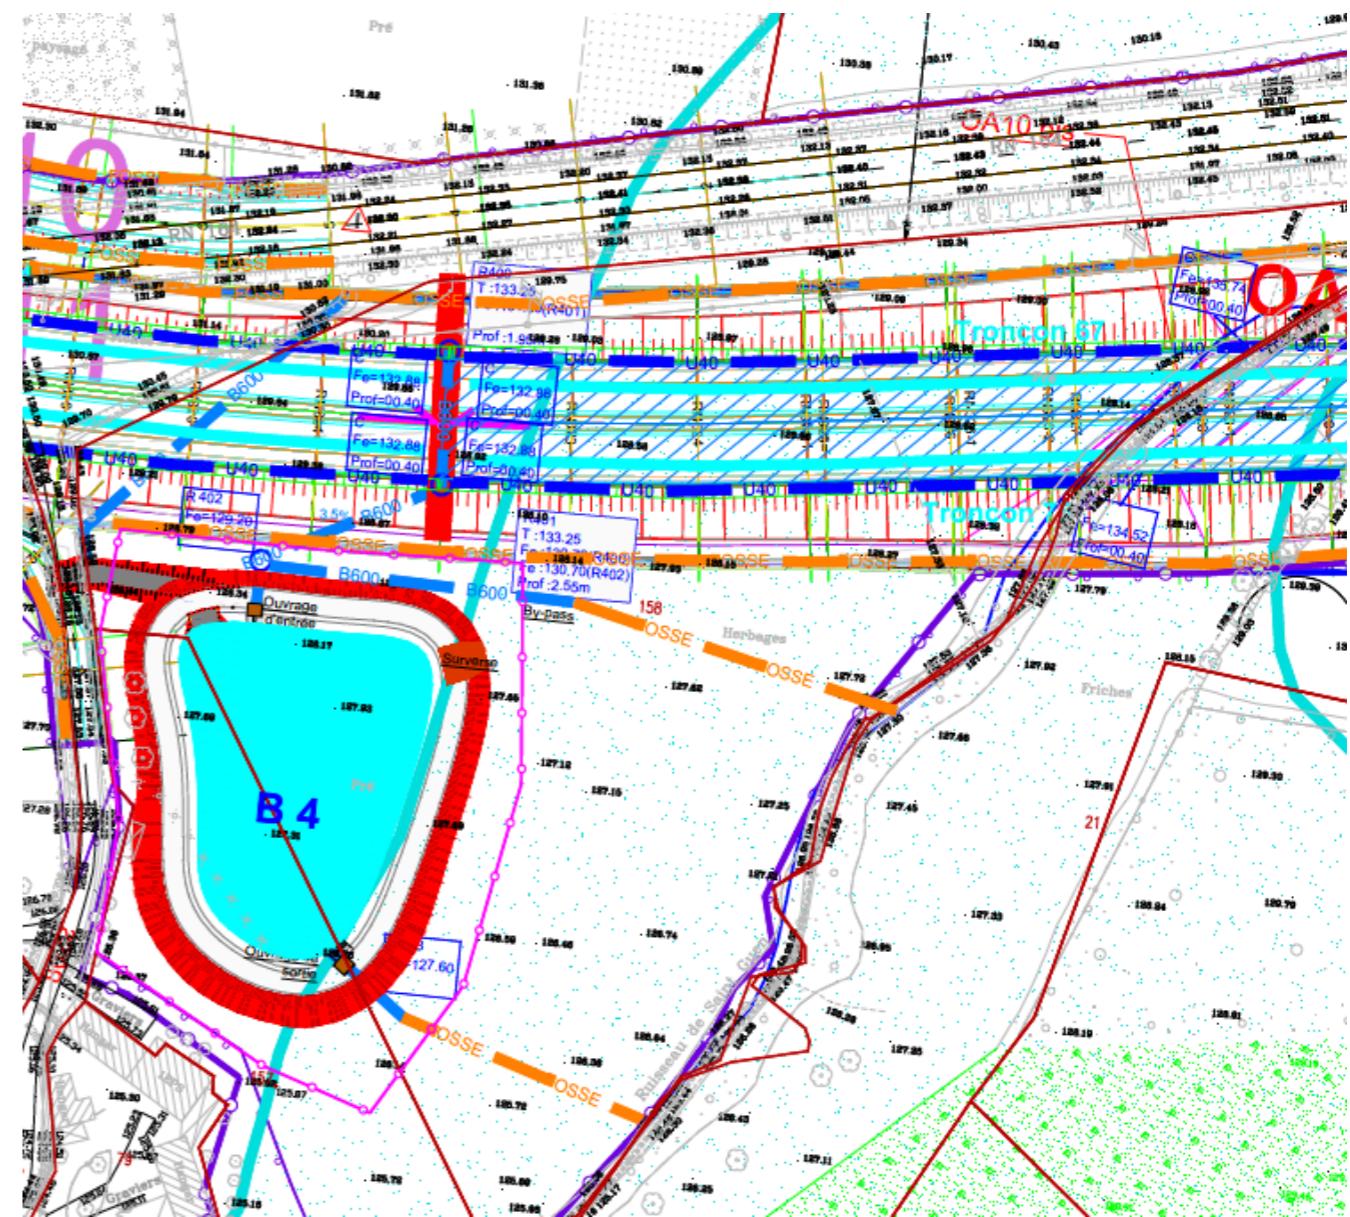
Plan d'assainissement du BR4 (source : SIR)
